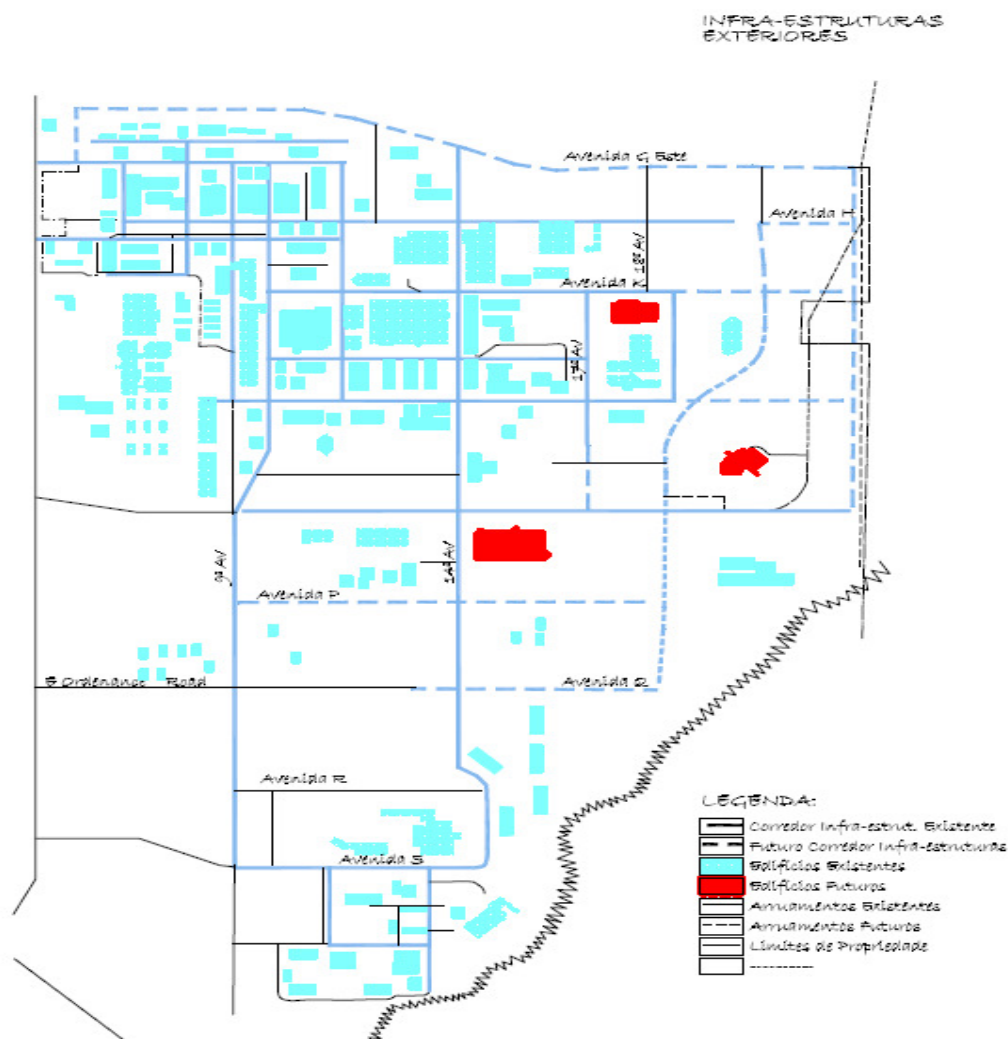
Traçado esquemático exemplificativo das Infra-estruturas exteriores.¹⁶³
